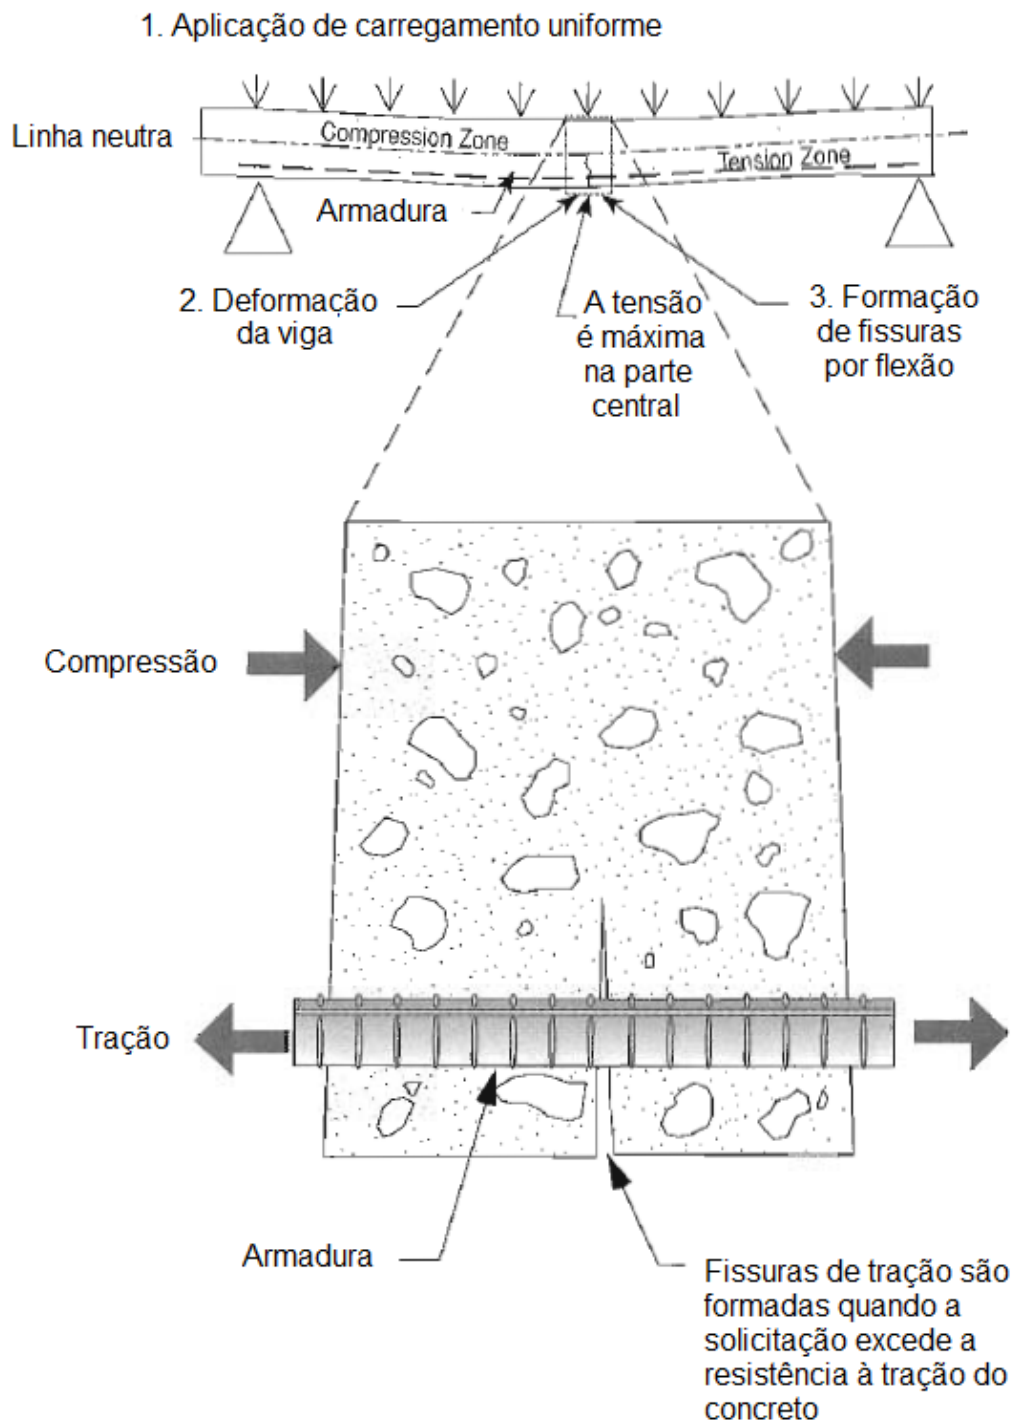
Viga de concreto armado simplesmente apoiada. (Fonte: Emmons, 1994 – adaptado).
